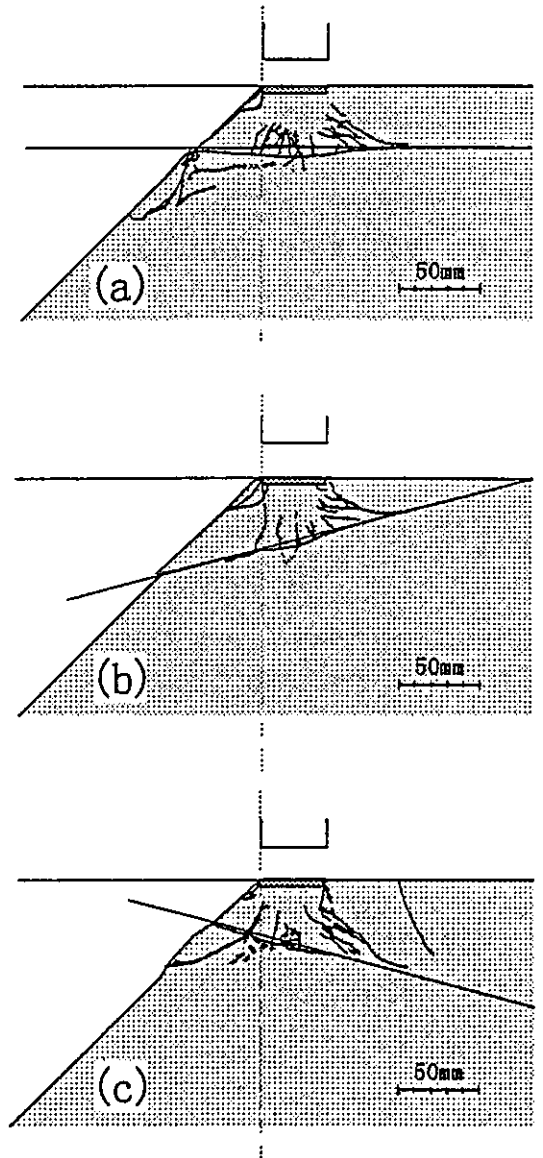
二層傾斜地盤 破壊状況 (断面図)
